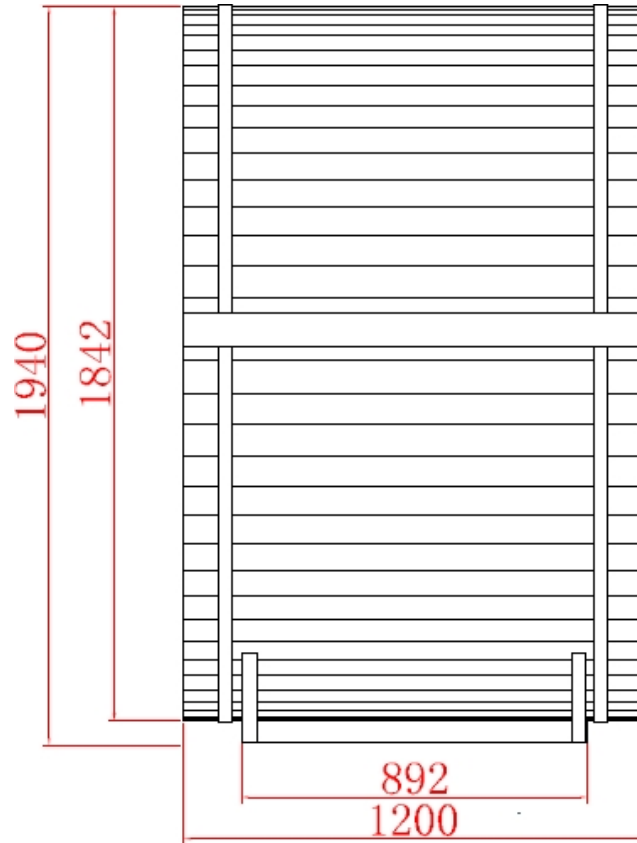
Croquis du Cube S, vue de profil avec dimensions en mm
